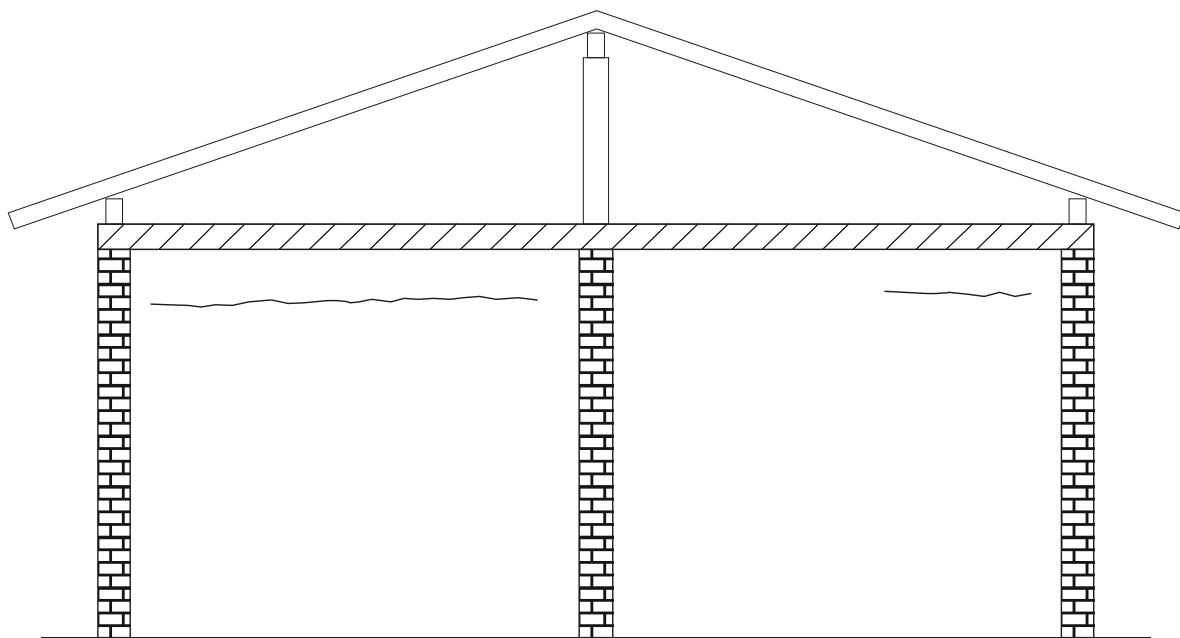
Fissuras horizontais de cisalhamento causadas pela movimentação térmica da laje de cobertura; as fissuras são mais acentuadas no topo das paredes.
